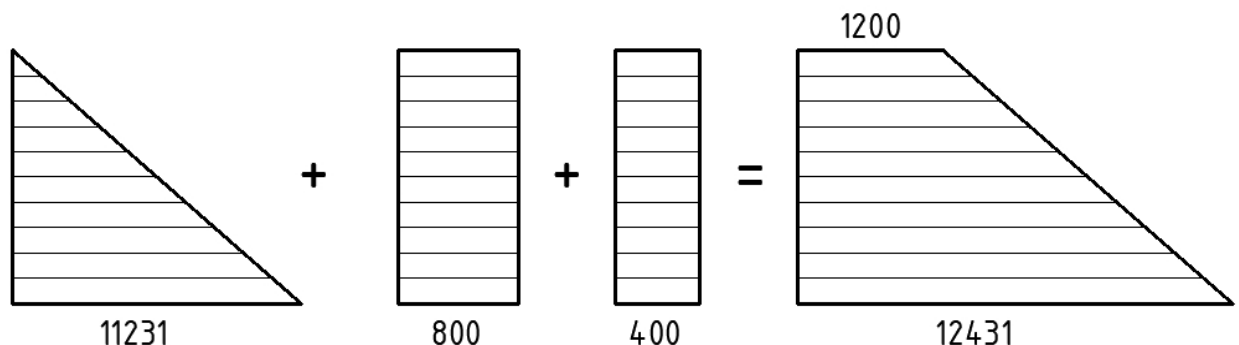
Эпюра распределения нагрузки на вертикальные элементы опалубки (кг/м²)
